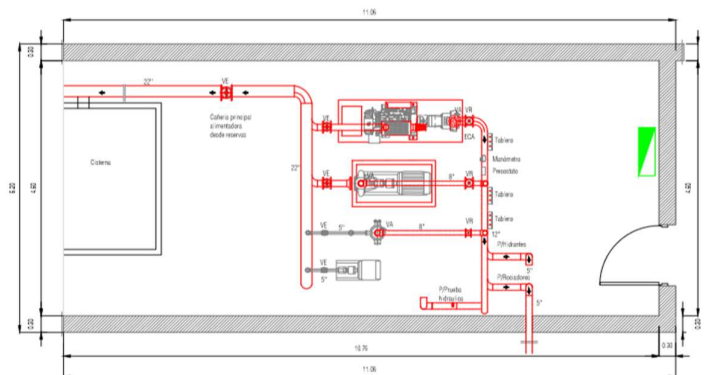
Detalle de sala de bombas en planta- Adjunto en Anexo 3. Plano N°14.
